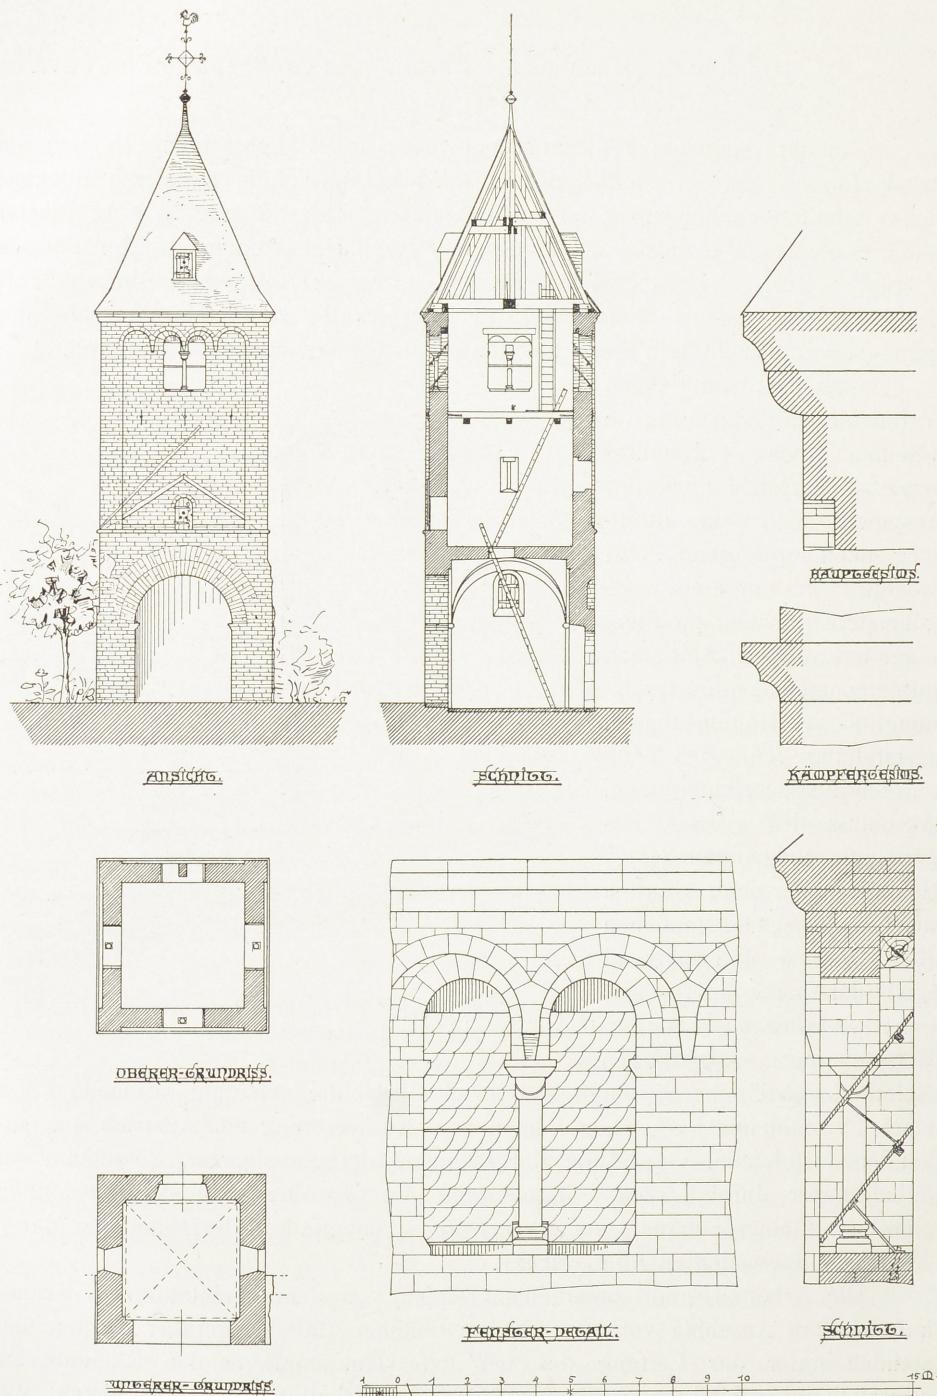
Heumar. Aufriss, Schnitt, Grundrisse und Details des Turmes der alten Kirche nach der Instandsetzung.
